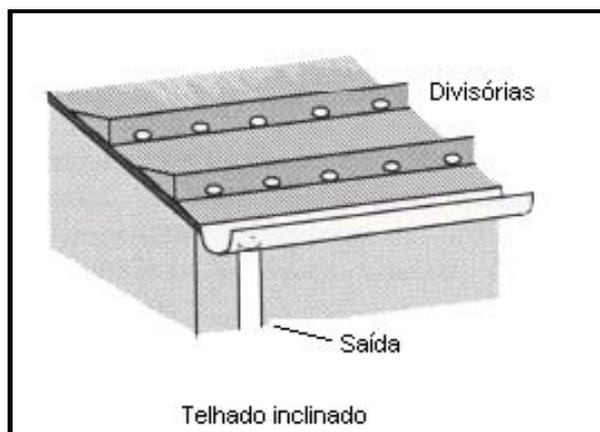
Esquema de telhado armazenador inclinado (CETE DU SUD-OUEST, 2003)
